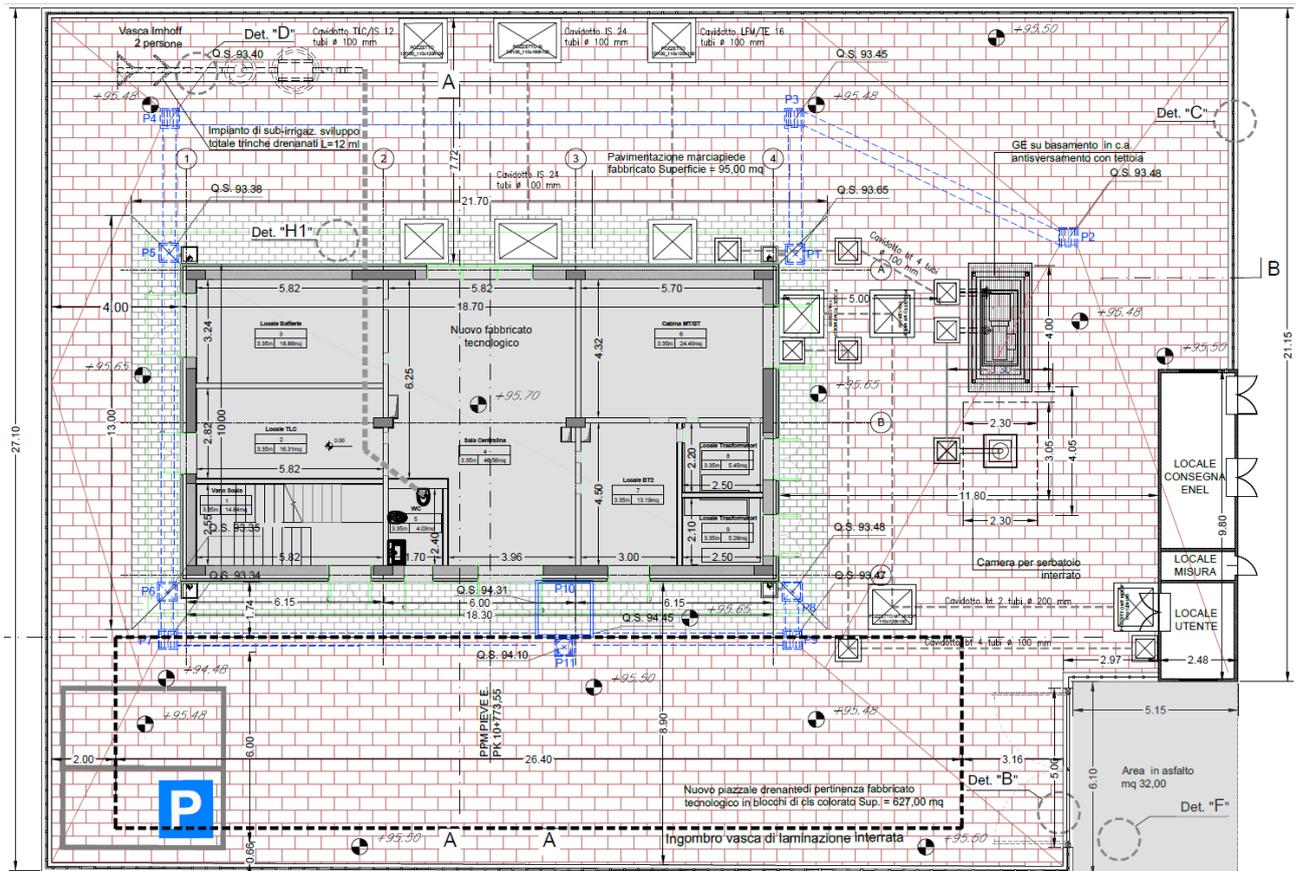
PPM Pieve Emanuele -Planimetria di progetto
